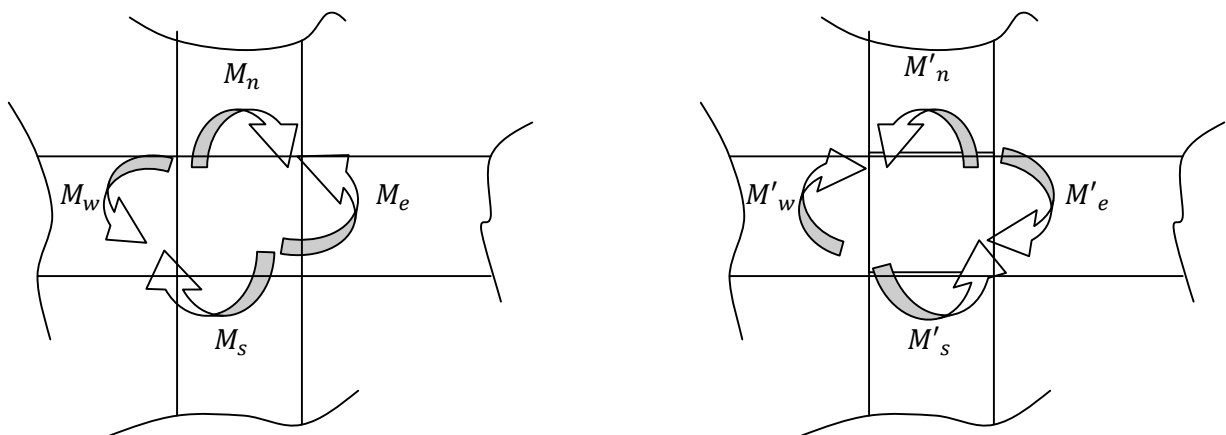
Dimensionnement d'un nœud Poteau-poutre [19]
